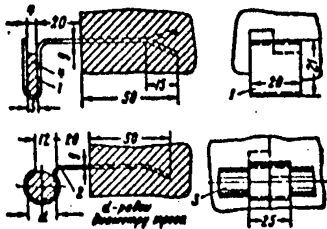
Крепление заземляющего проводника в камере с бетонной крепью:
